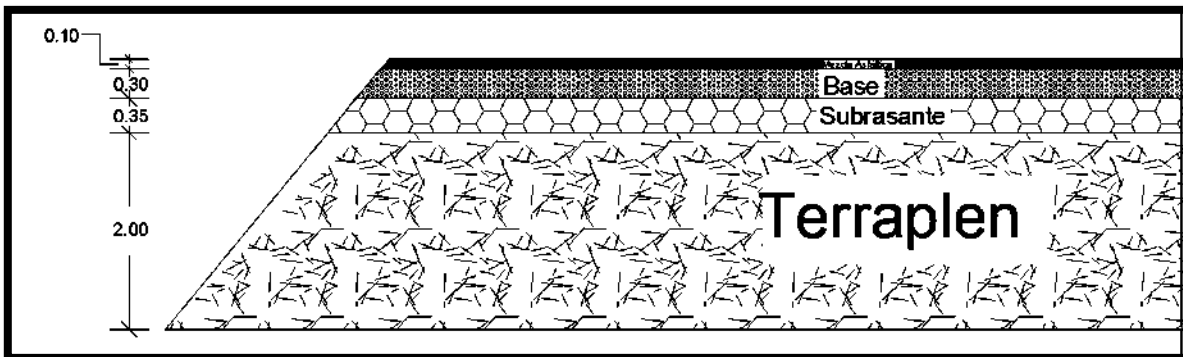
Sección de pavimento del catalogo español 3221 (espesores en m.)
